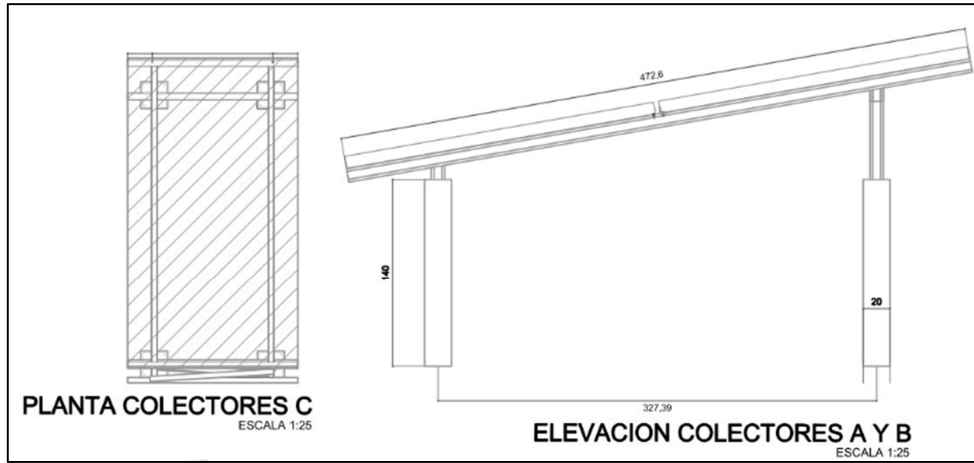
PLANTA Y ELEVACIÓN DE COLECTORES
